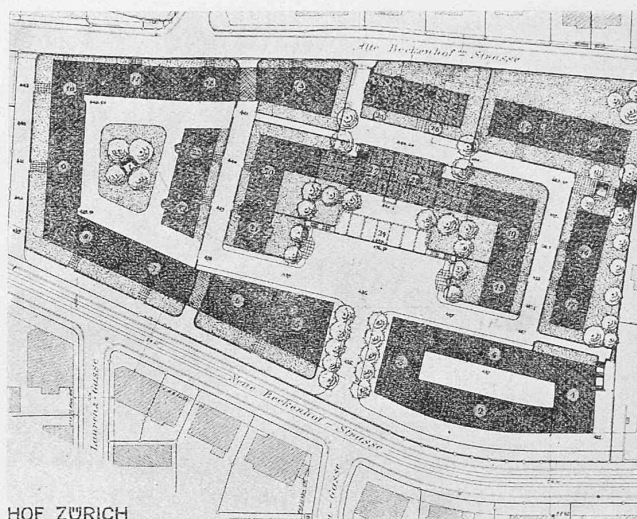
Entwurf Nr. 5. Arch. H. Weideli. — Lageplan 1:2000.
